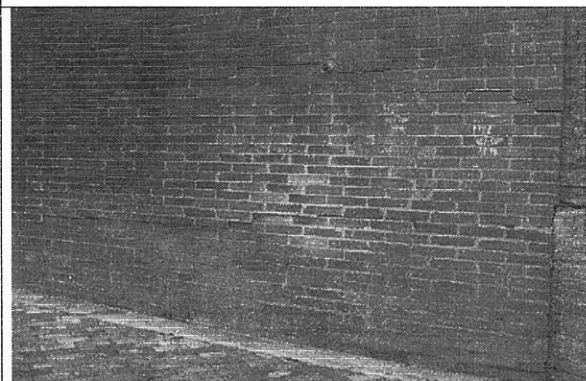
Muro sobre la calle 33 en mal estado, agrietamiento extremo occidental
